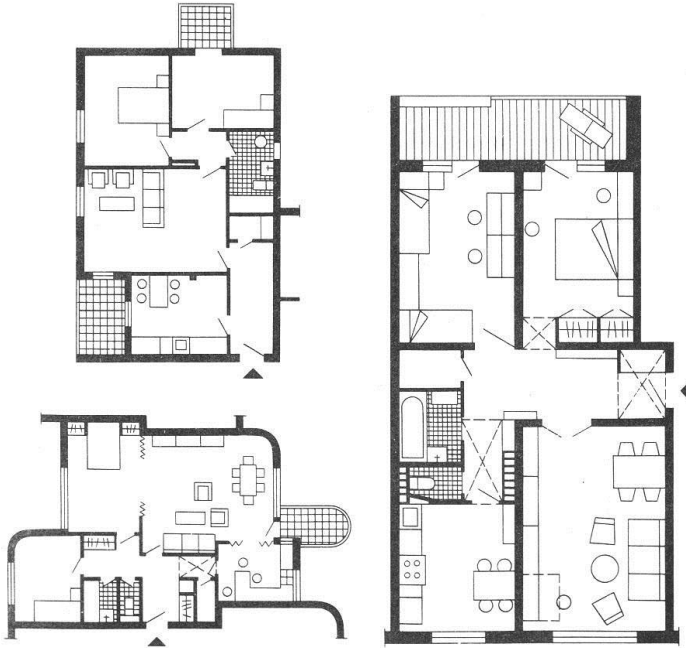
Примеры планировочных решений трехкомнатных квартир.
